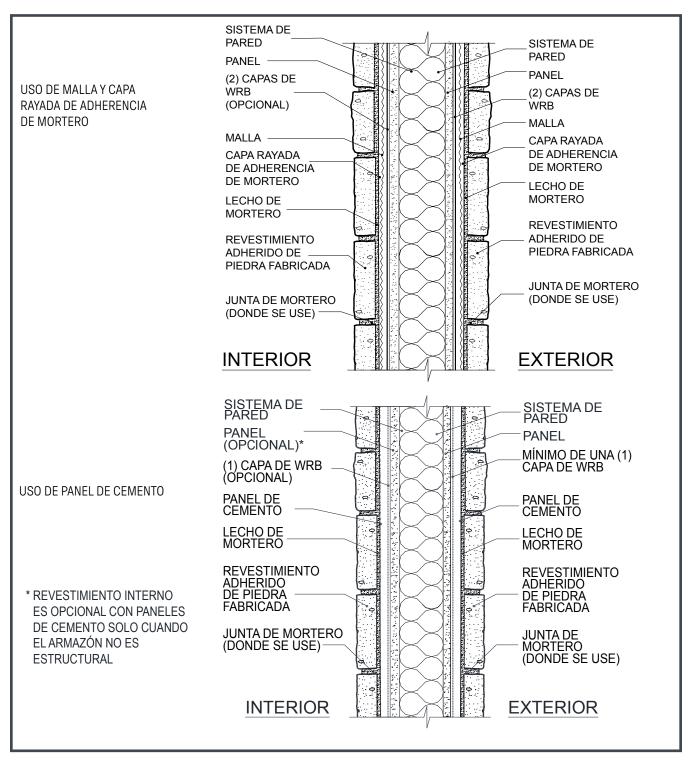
Sección de muro de armazón típica con aislamiento rígido continuo
